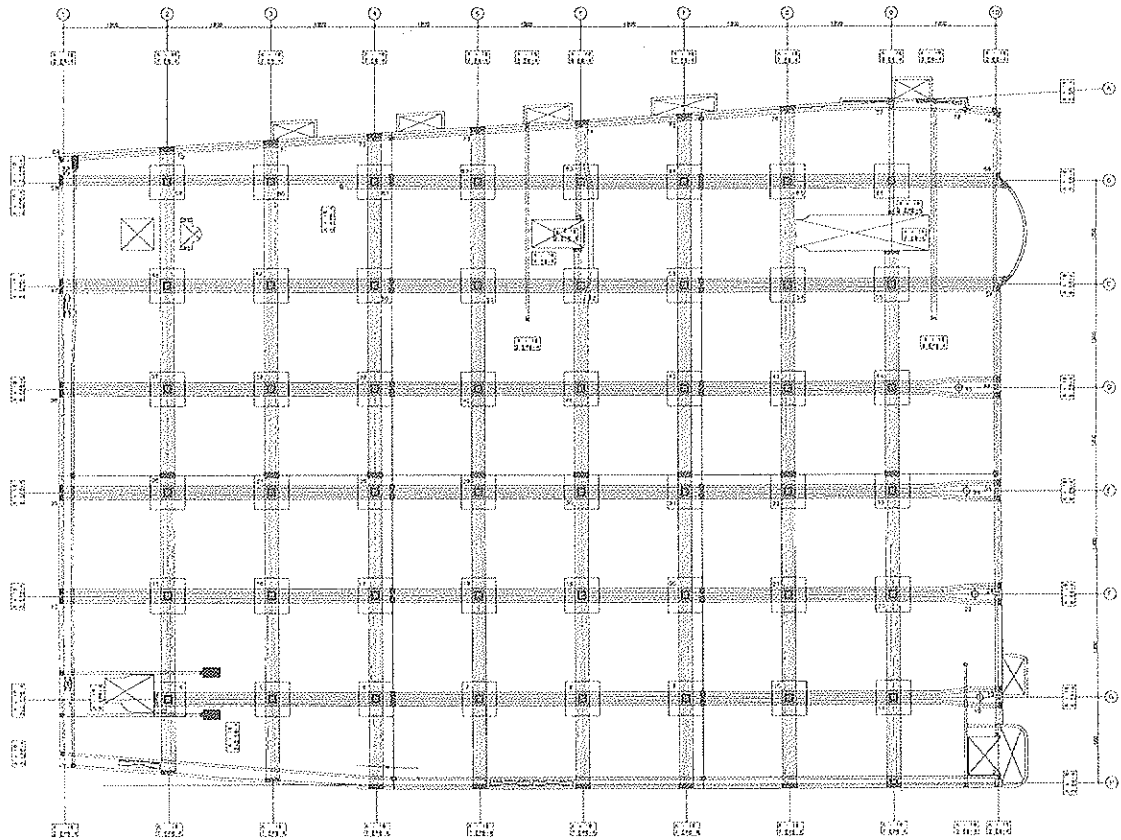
Distribución en planta de los tendones de pretensado del primer nivel.
